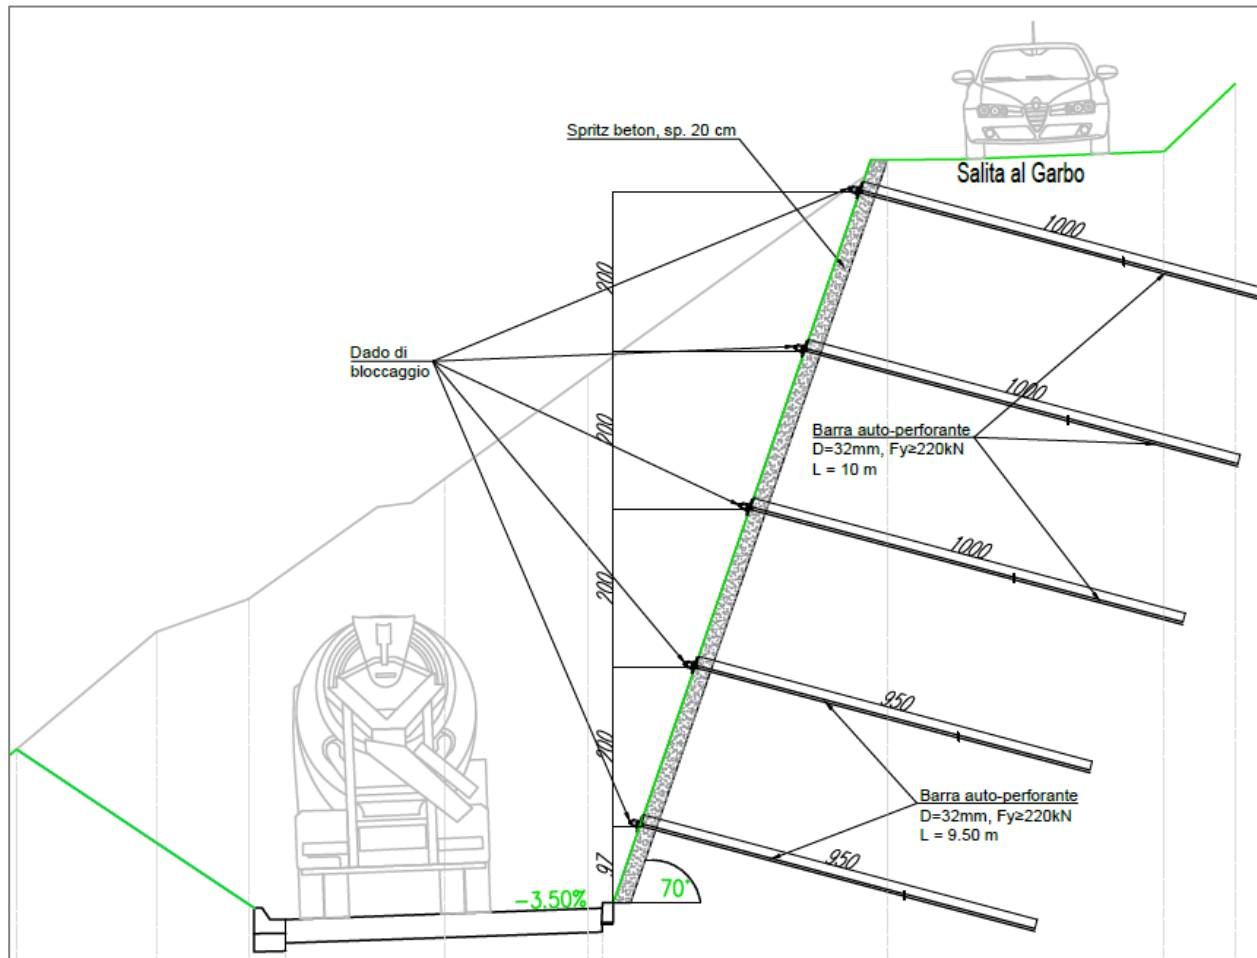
Estratto della sezione tipo del terzo tratto
